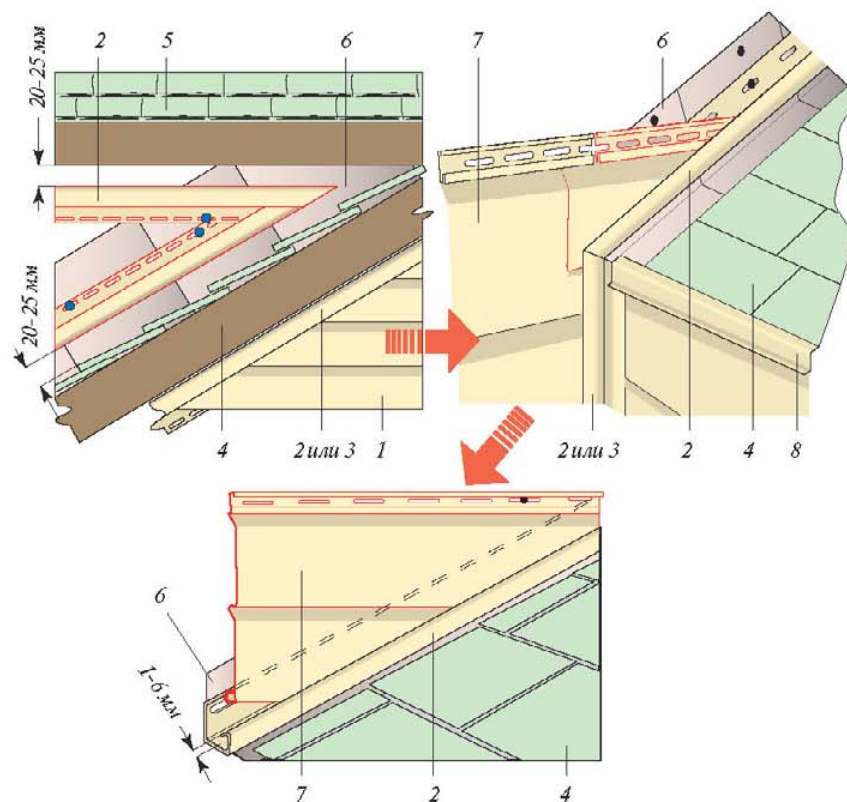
Обшивка сайдингом стен, примыкающих к крышам: 1 — обшивка фронтона; 2 — J-профиль; 3 — угловой профиль; 4 — крыша над фронтоном; 5 — крыша над примыкающей стеной; 6 — гидроизоляция из жести; 7 — рядовой сайдинг; 8 — отлив на крыше
